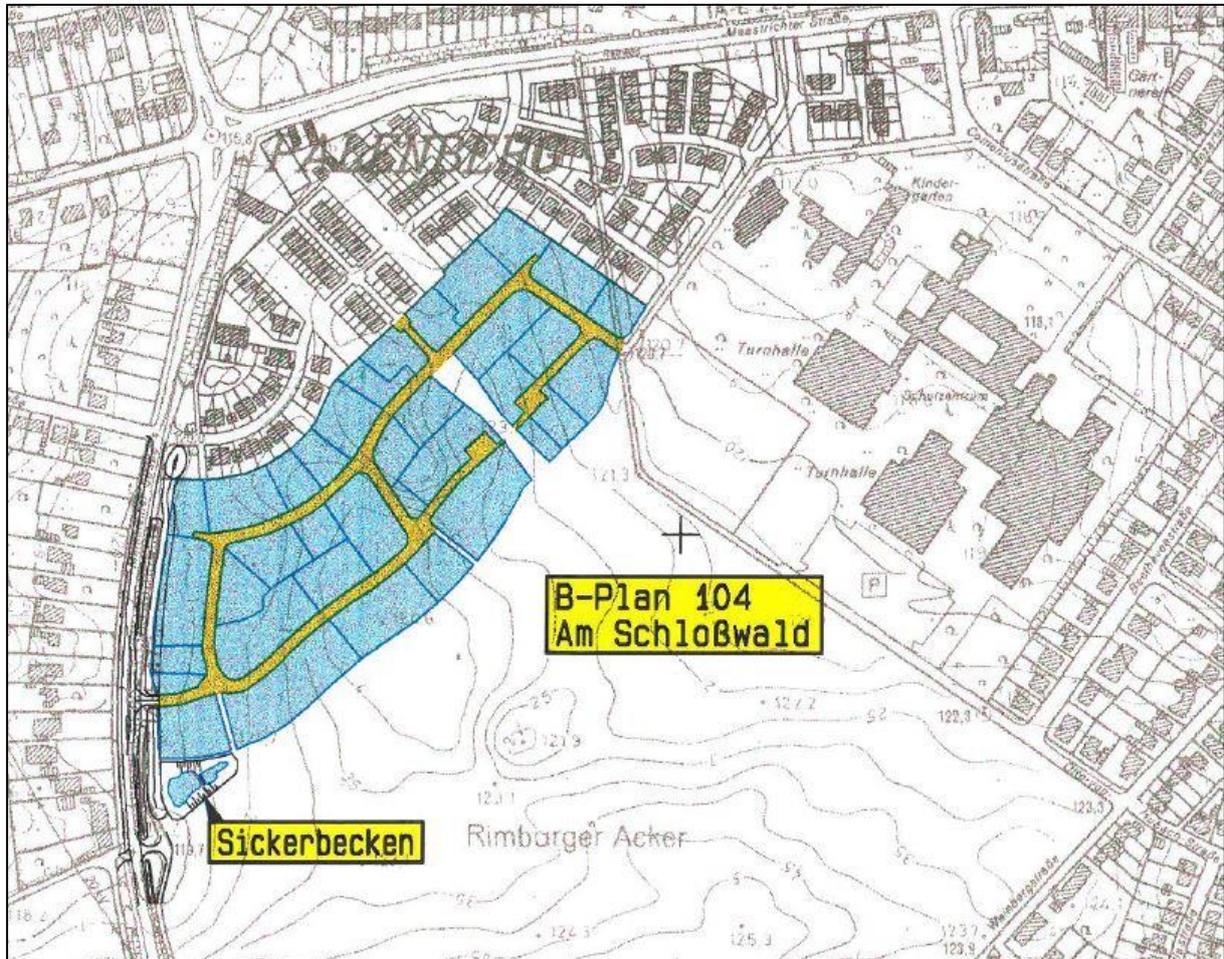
Ausschnitt Lageplan (LP_Büro_Brendt_ErlaubisantragRVB_2002)
